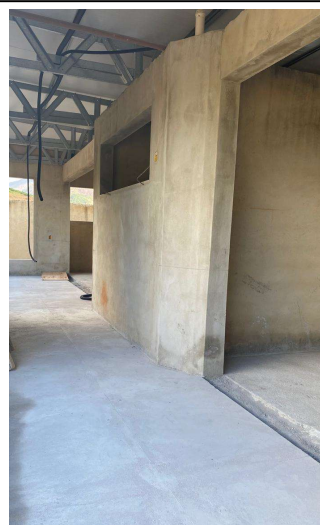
PAREDE COM PLACAS DE GESSO ACARTONADO (DRYWALL).
